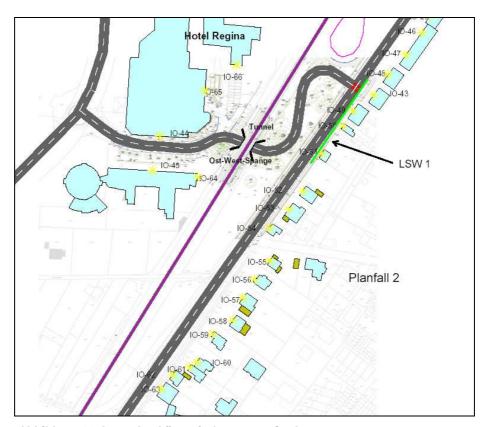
Lageplan Lärmminderungsmaßnahmen
